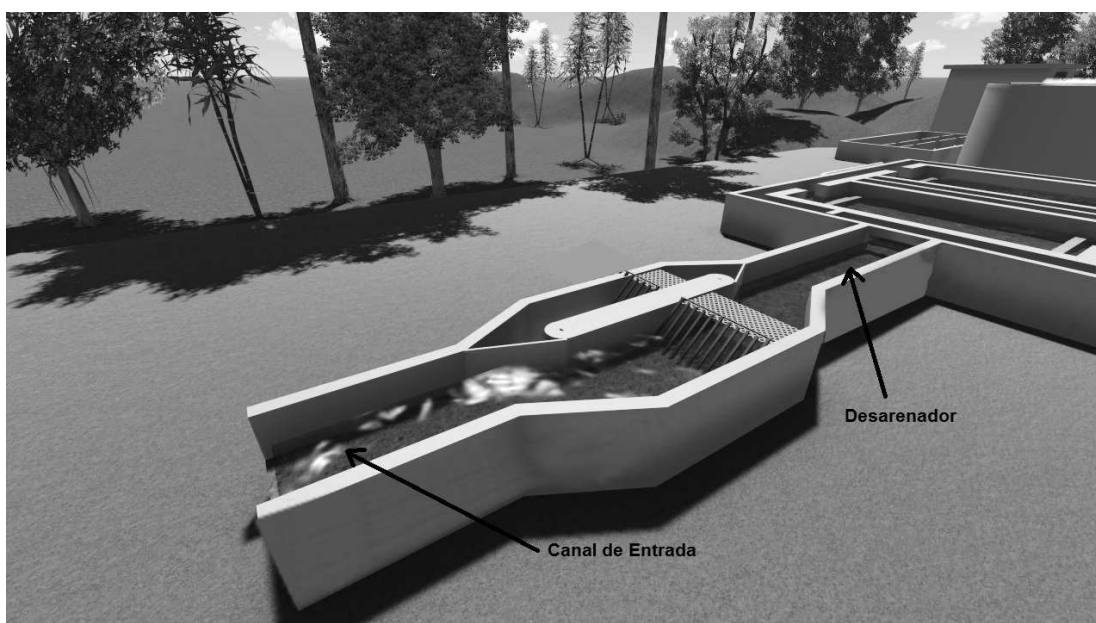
Vista en 3D de un canal de entrada, las rejillas y el desarenador
